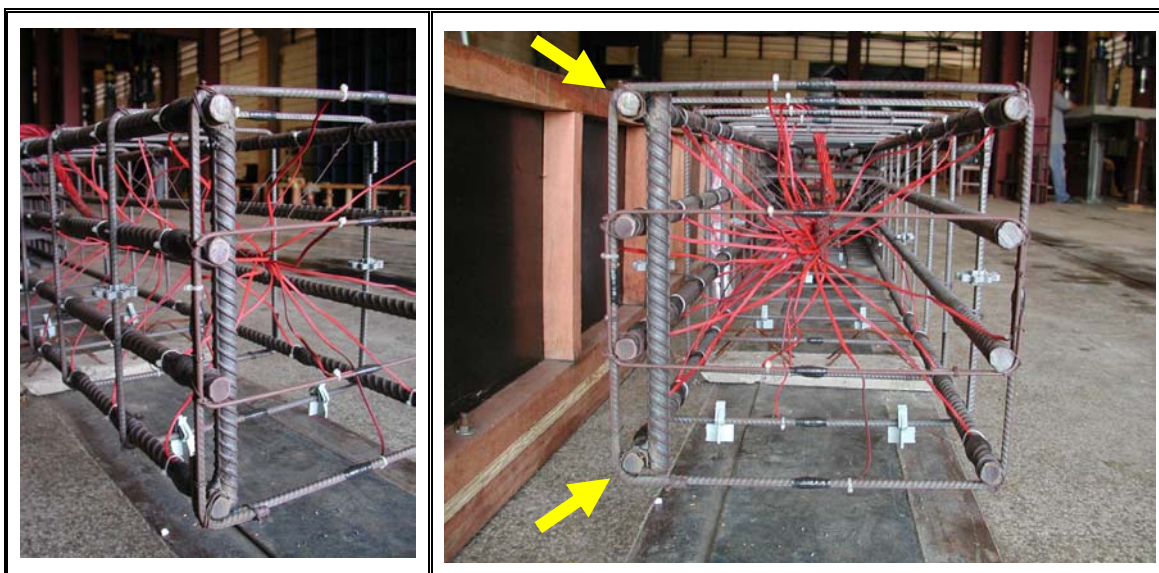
Barra transversal soldada à armadura longitudinal tracionada
